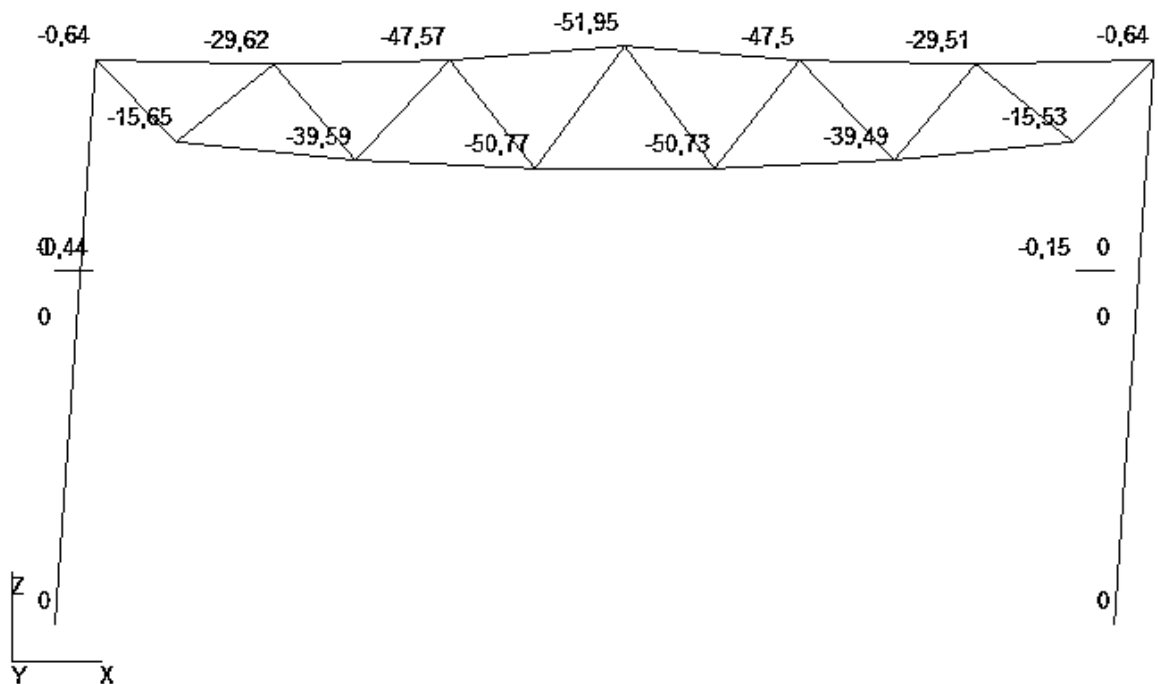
Значения перемещений в узлах поперечной рамы по оси Z от сочетаний нормативных нагрузок
